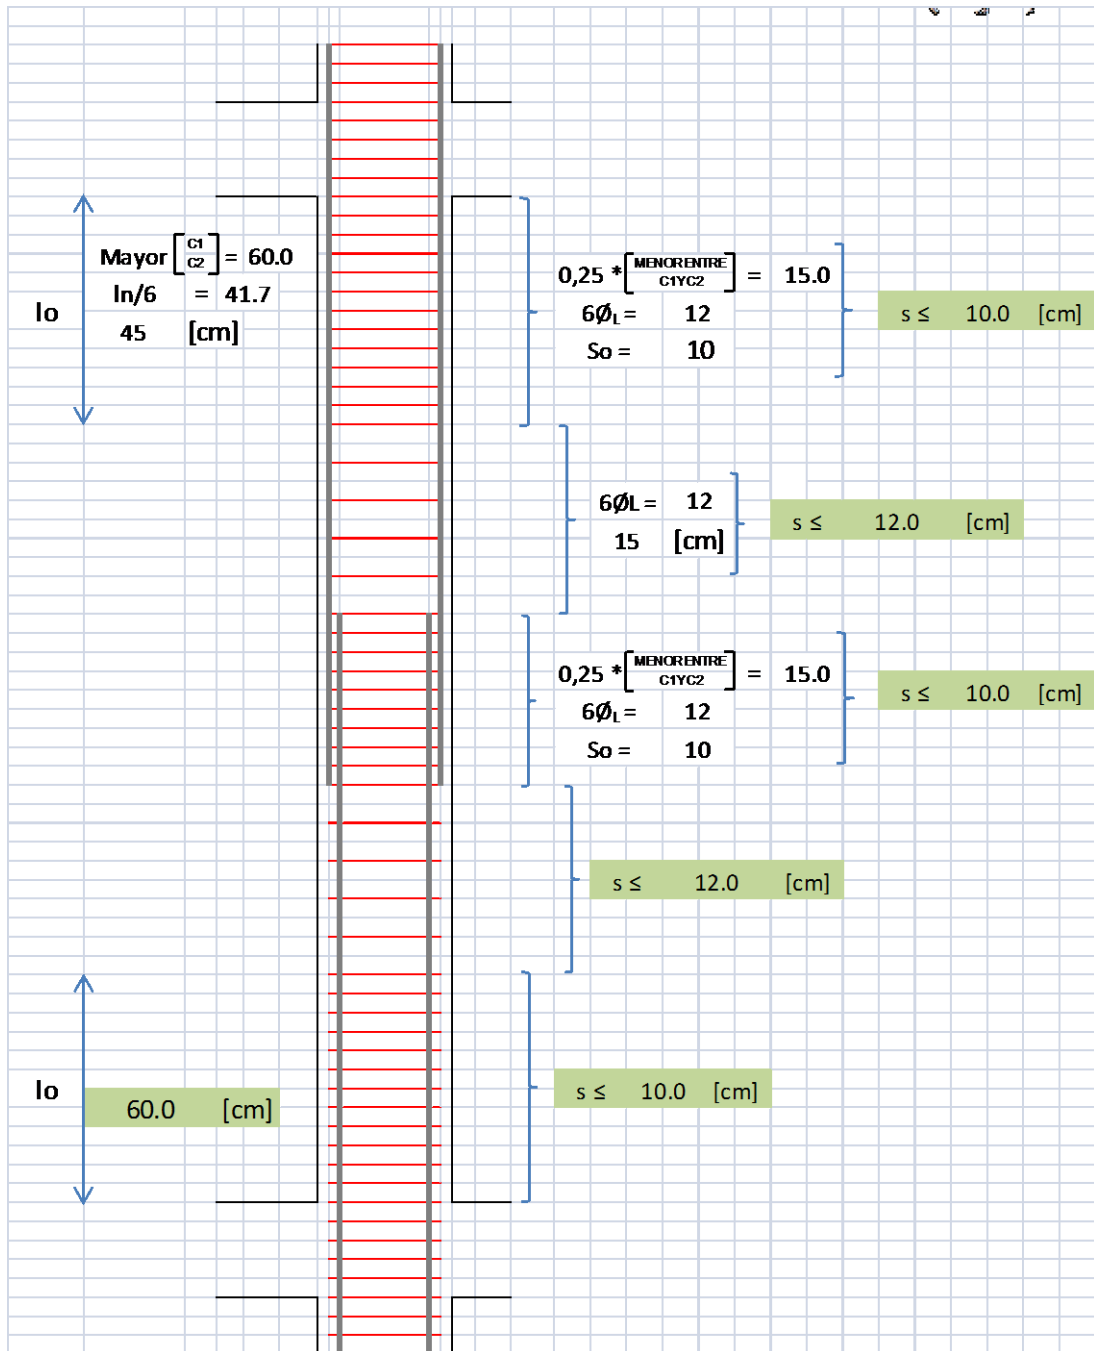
Armadura transversal para la columna de 60x60 cm.
